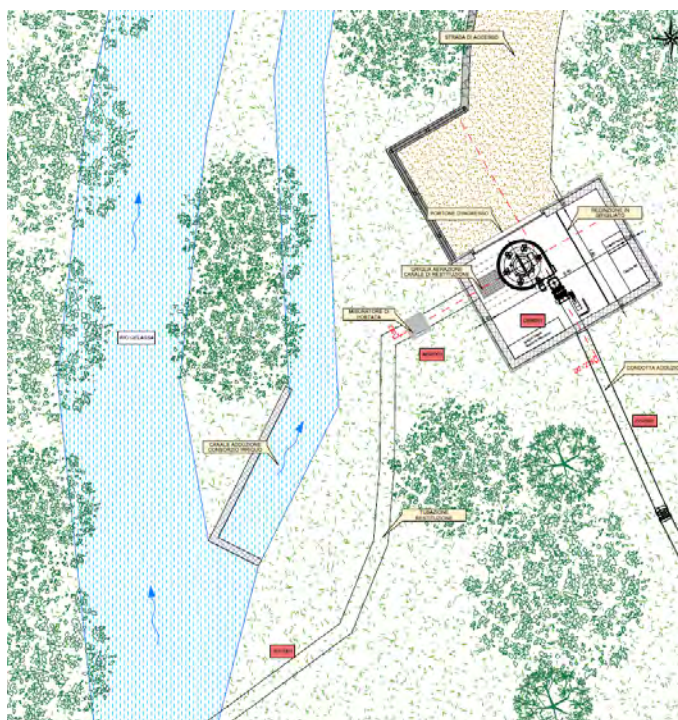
Posizione della centrale rispetto al corso d’acqua.
